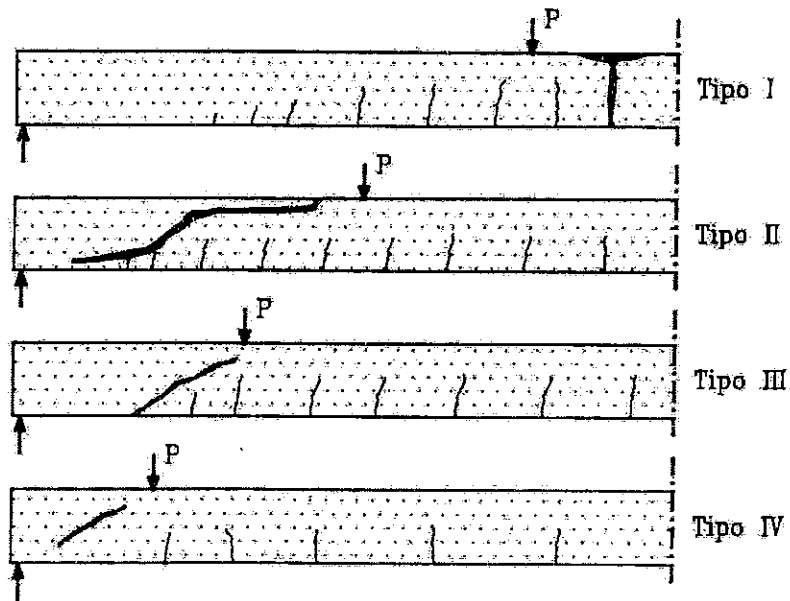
Tipos de comportamento de vigas de concreto armado sem armadura transversal (DURÃO-1993)
